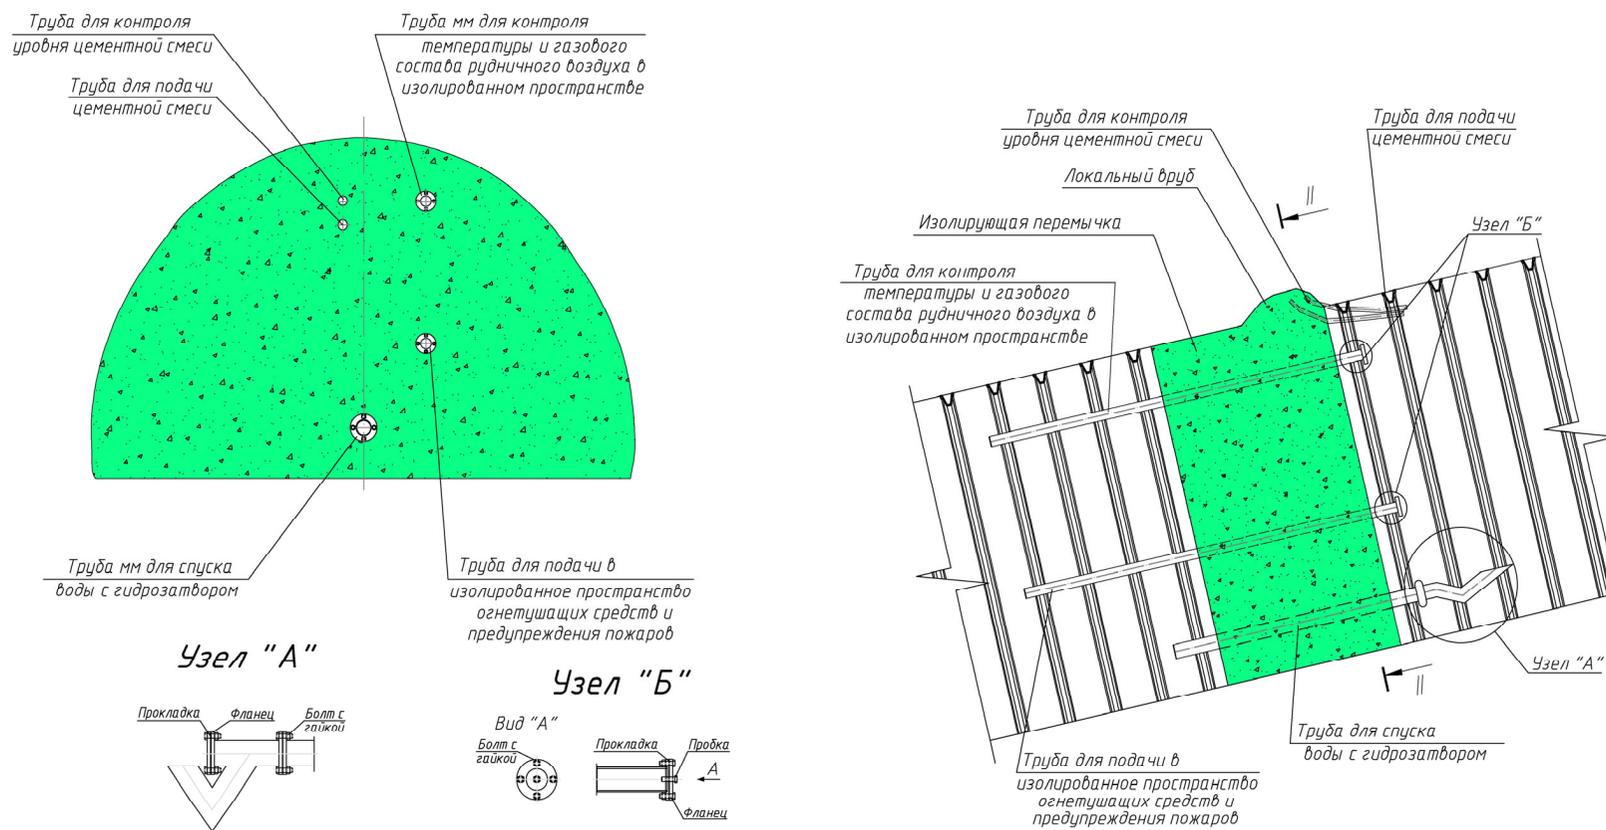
Конструкция взрывоустойчивых перемычек
